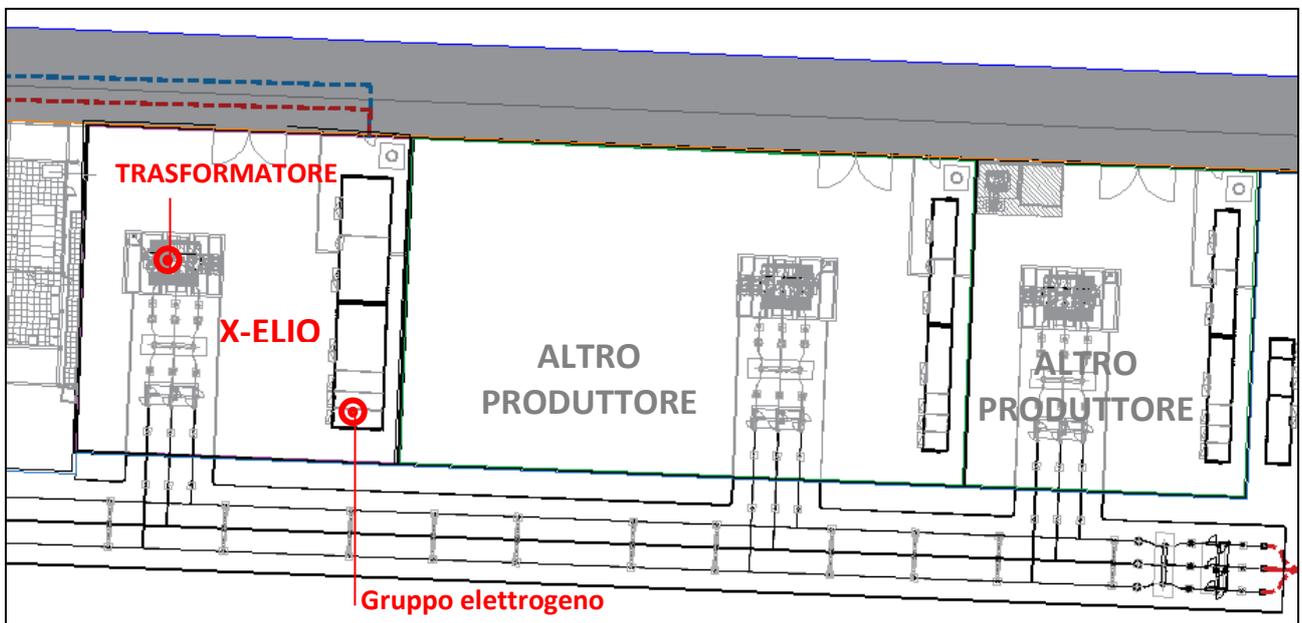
stralcio elaborato di progetto STAZIONE UTENTE
